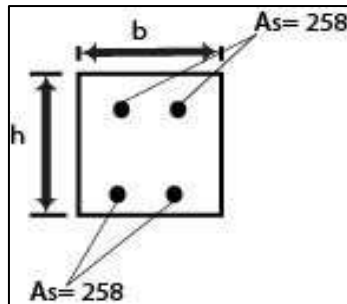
Ilustración de separación entre varillas; Fuente [Grupo investigador]
